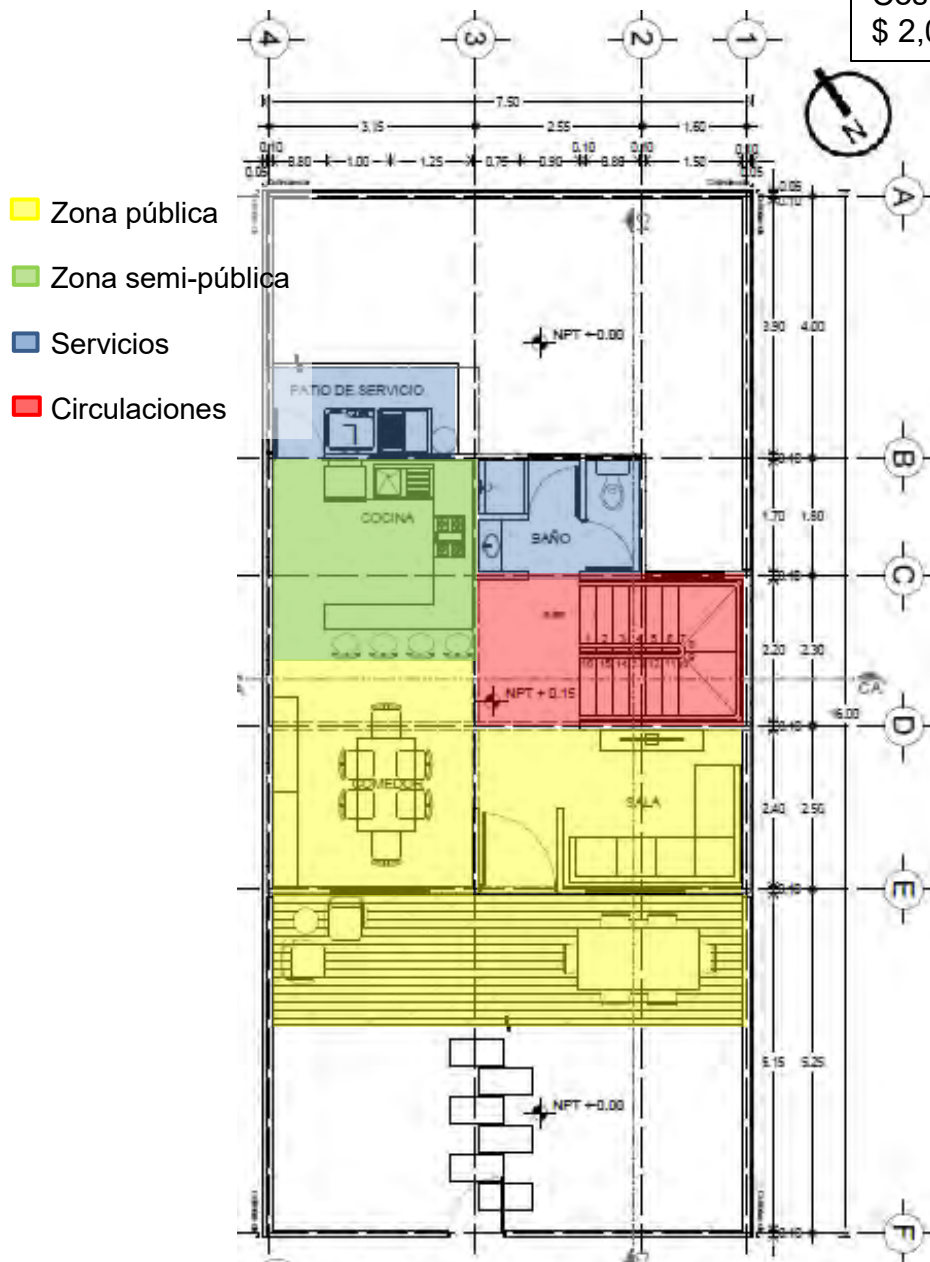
Planta arquitectónica de prototipo de vivienda B1. Tercera etapa, planta baja.
